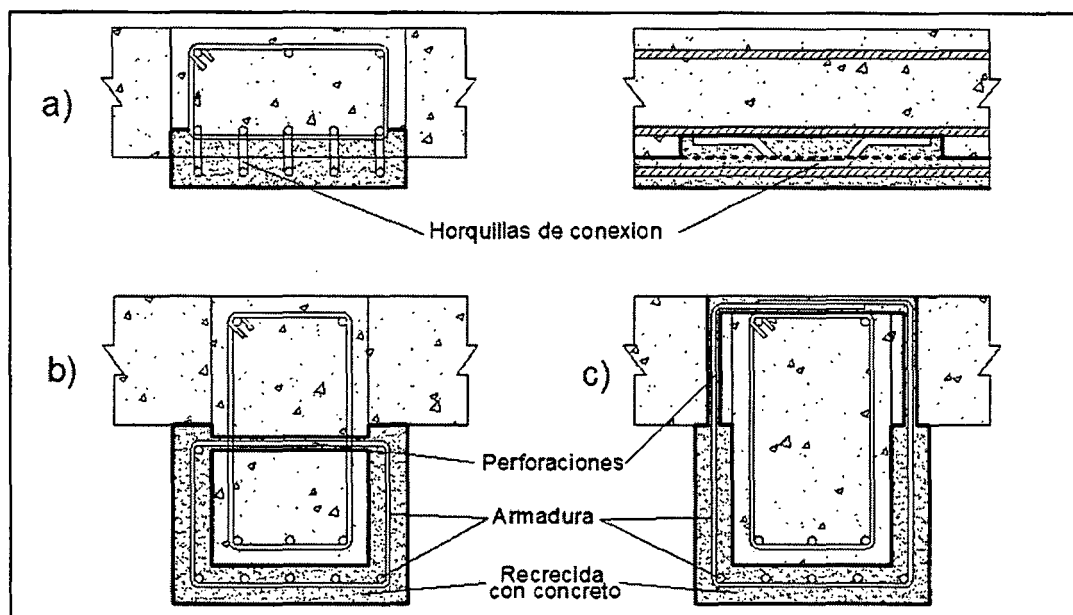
Refuerzo de vigas mediante recrecido con concreto armado.
